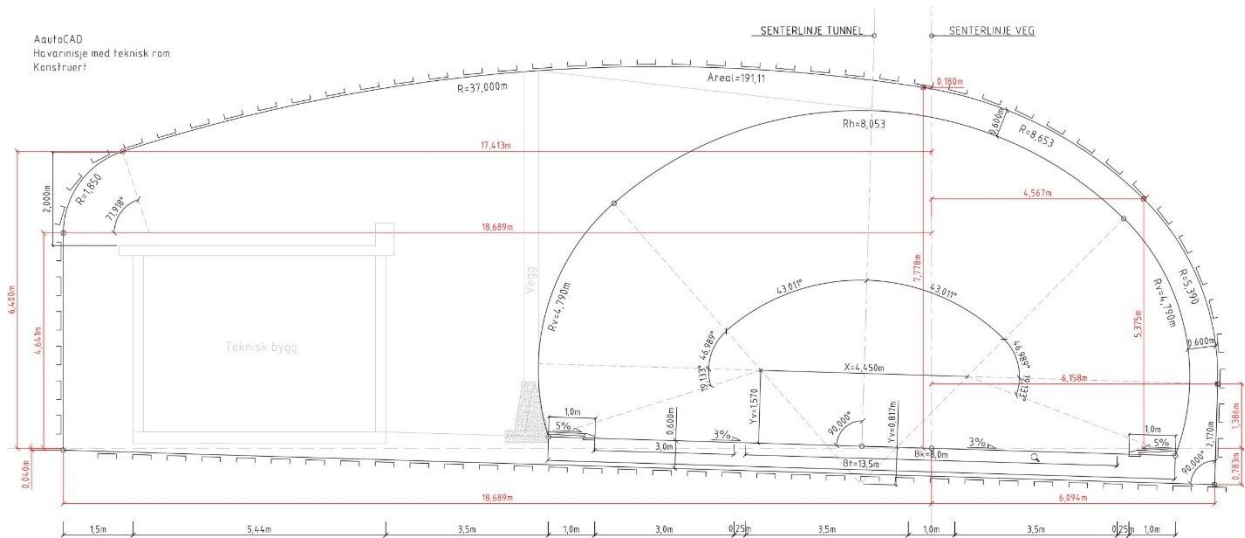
Tunnelprofil med havarinisje (T13,5) fra Gemini Terreng og målsatt i AutoCAD.
